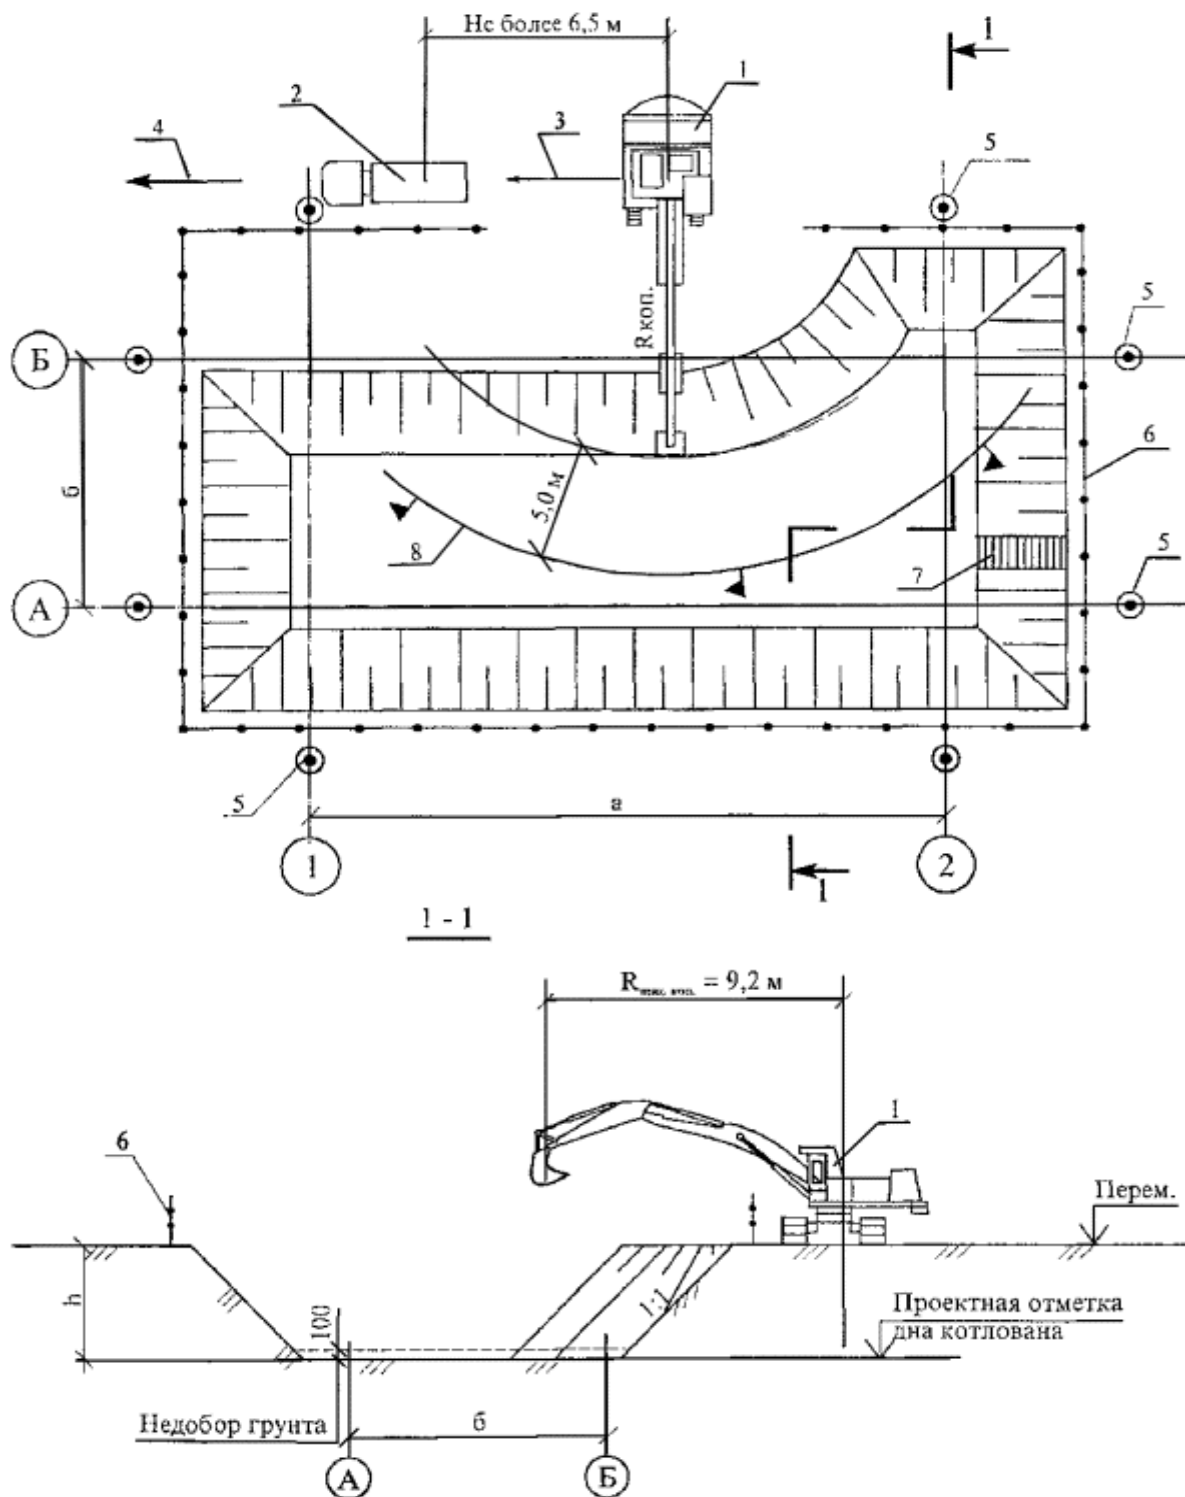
Схема разработки грунта котлована при боковой проходке
